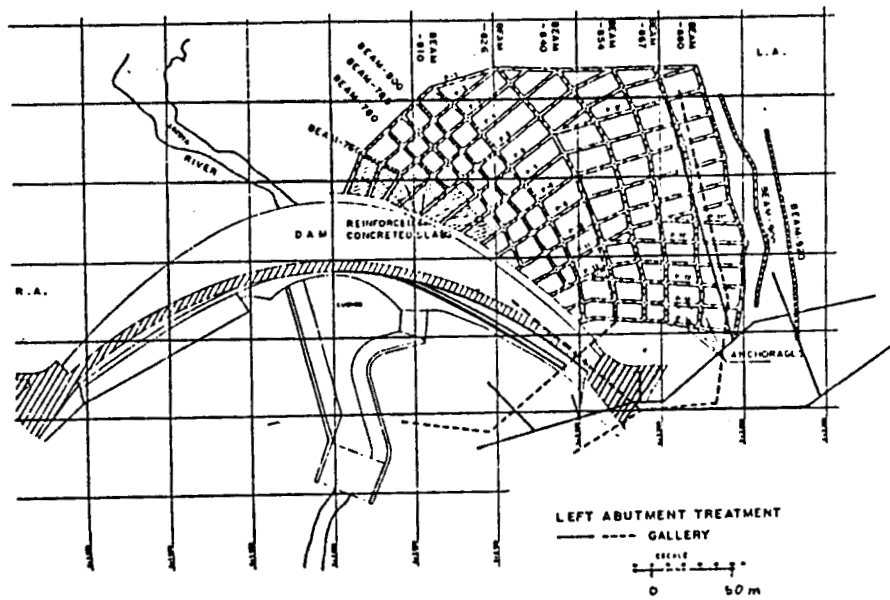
EMPARRILLADO ANCLADO EN EL ESTRIBO IZQUIERDO DE LA PRESA DE EL ATAZAR (Uriel, 1978).
